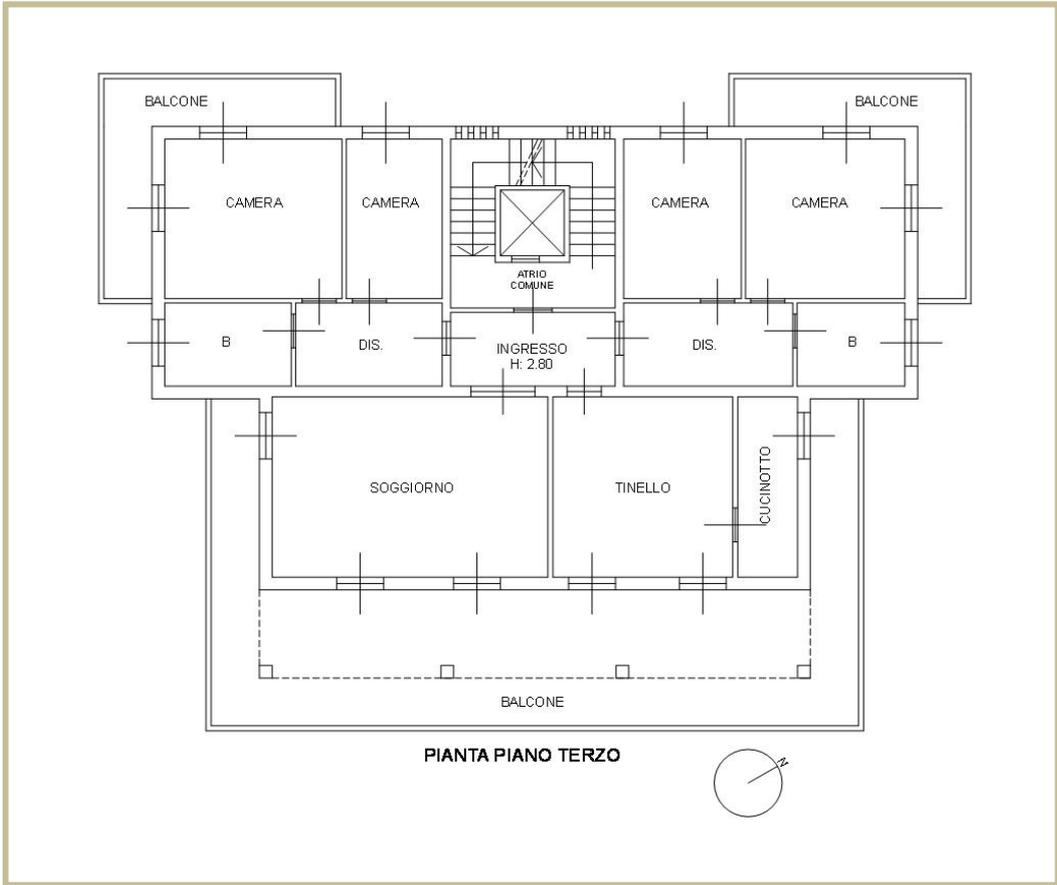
PIANTA P3 STATO LEGITTIMATO
